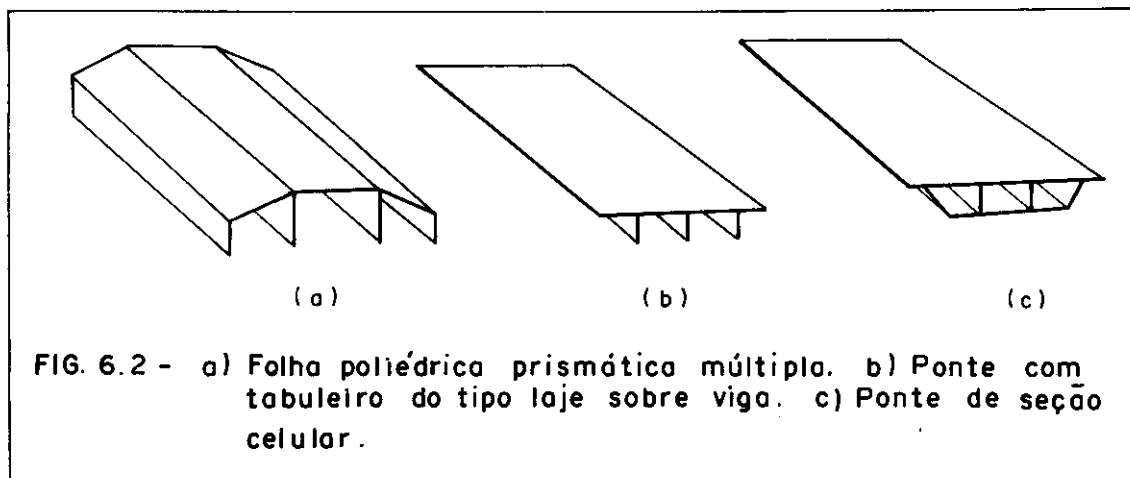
a) Folha poliédrica prismática múltipla. b) Ponte com tabuleiro do tipo laje sobre viga. c) Ponte de seção celular.
